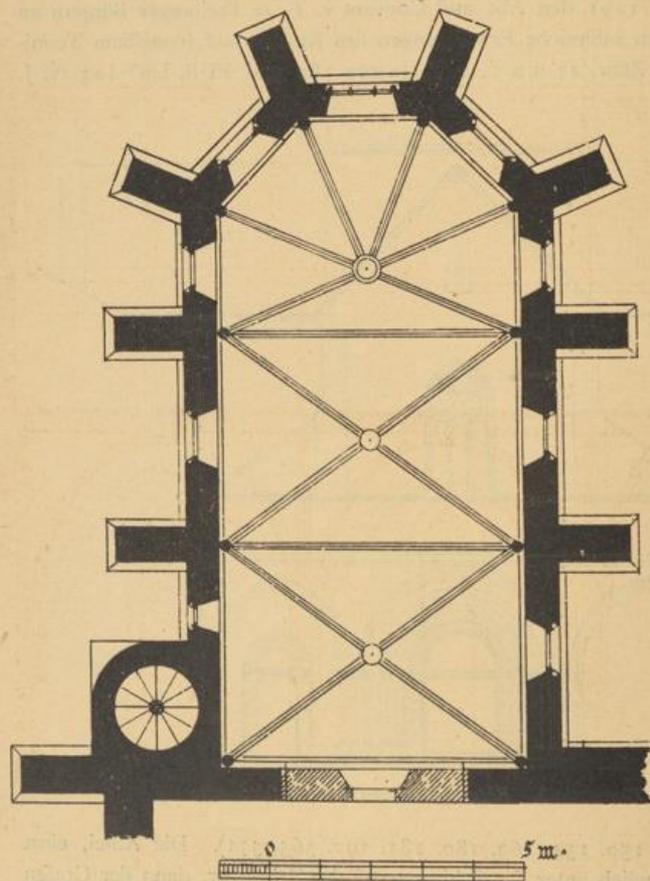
Thennenbach. Grundriss der Kapelle.
